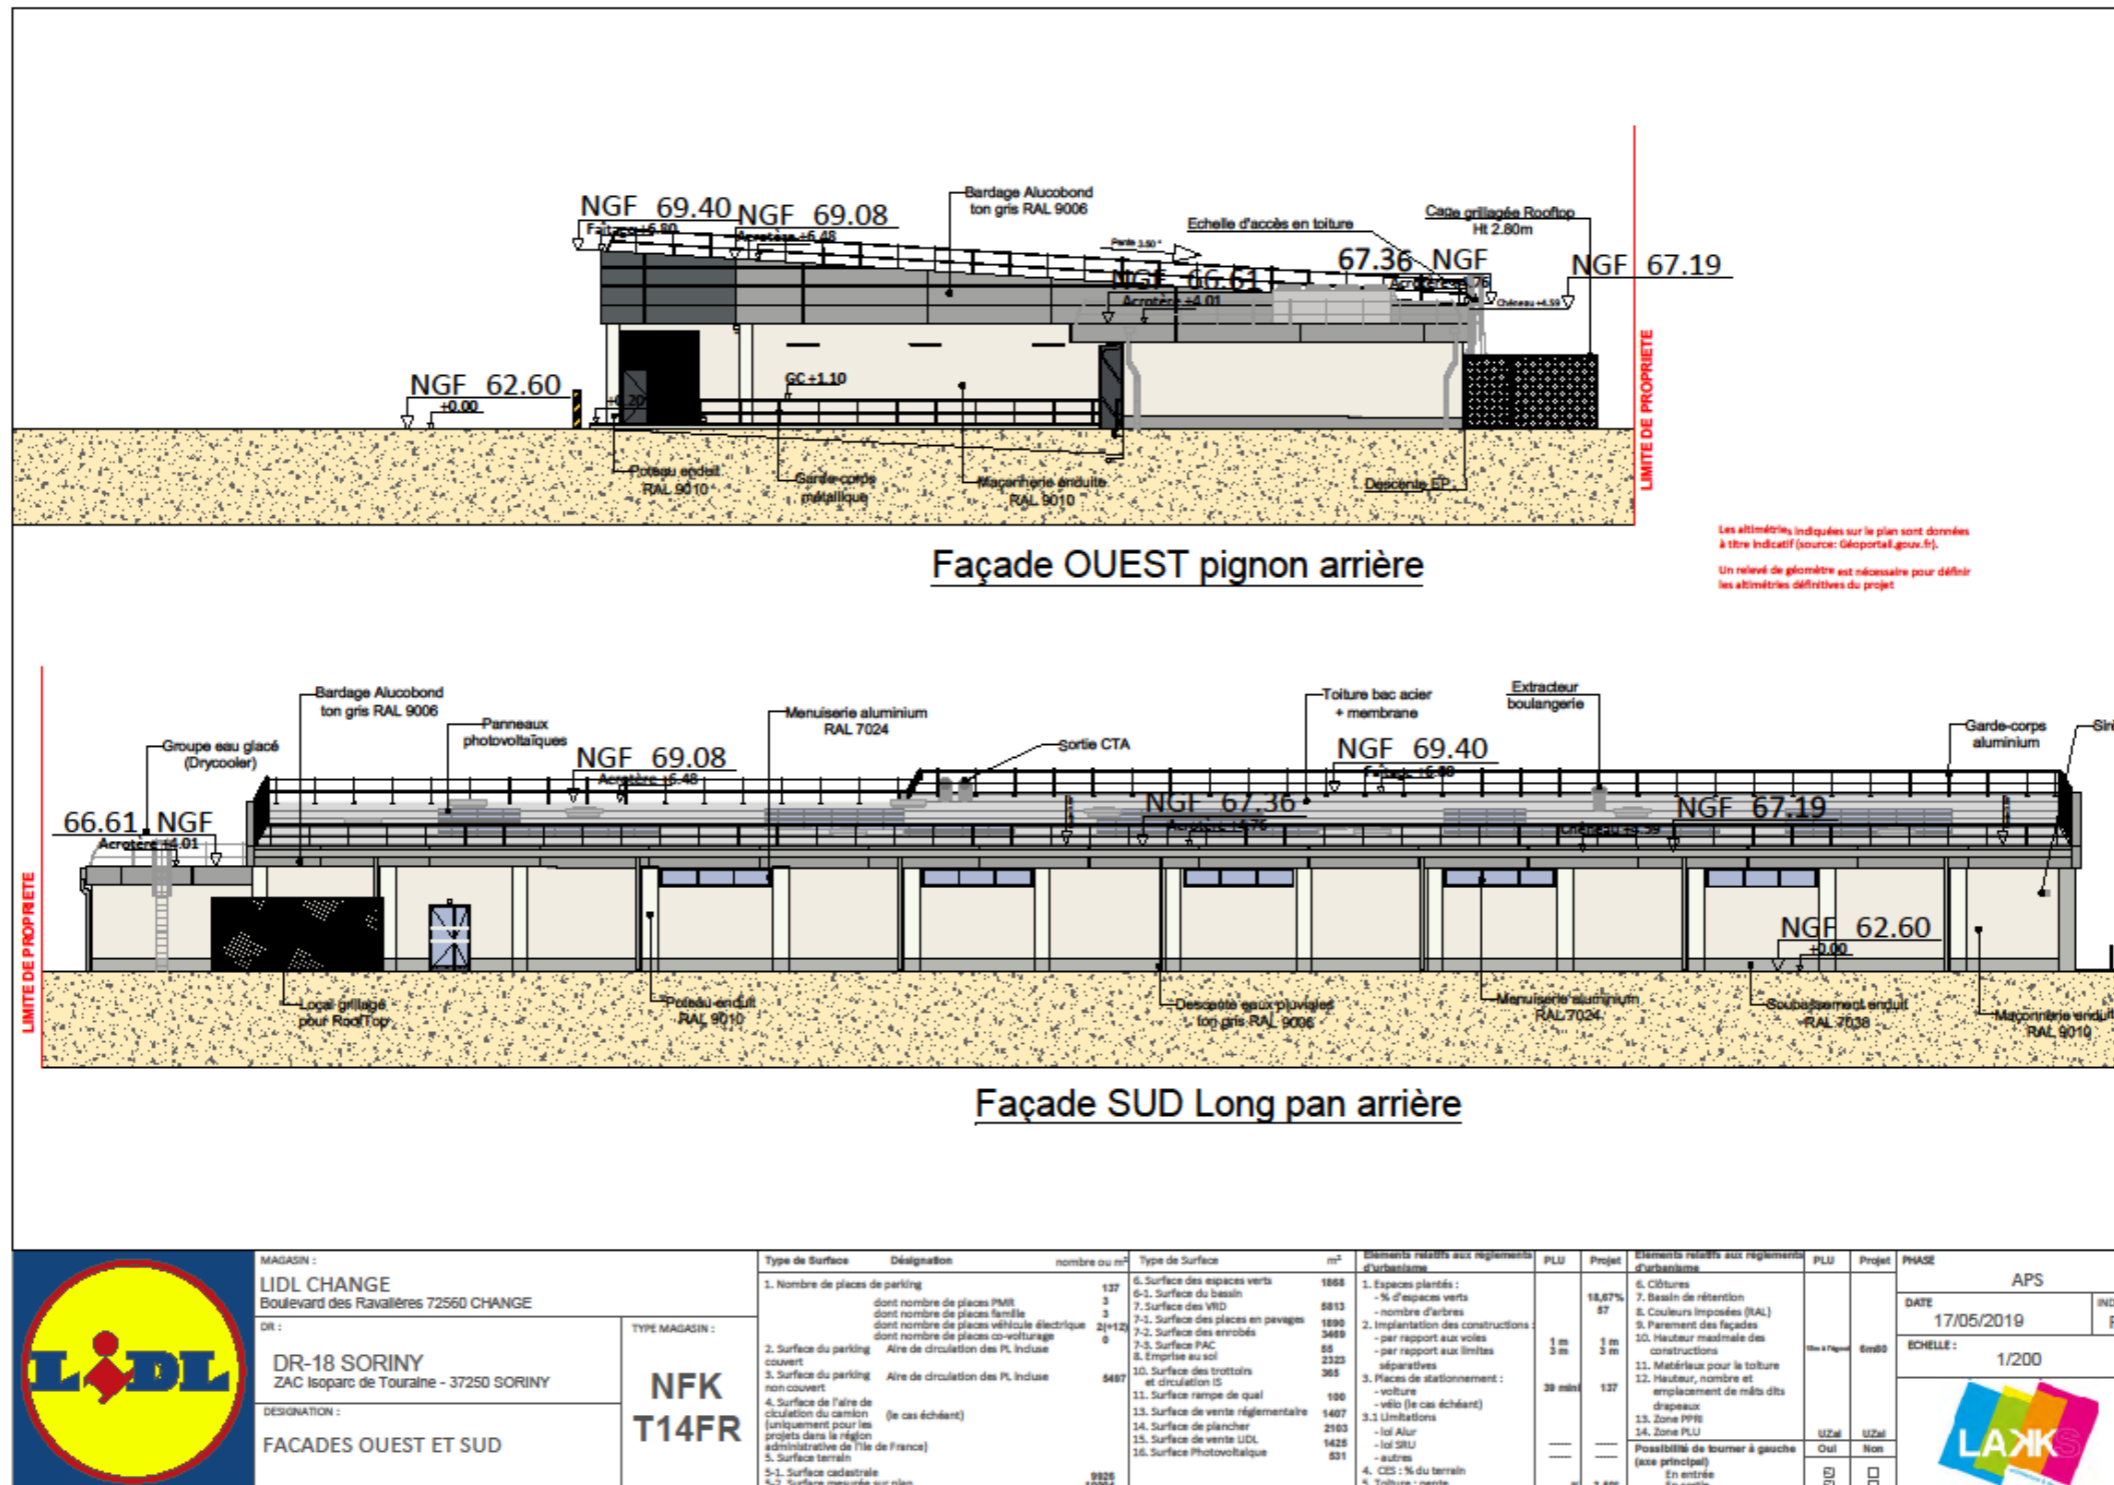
Plan des façades ouest et sud du projet de surface commerciale LIDL à Changé
